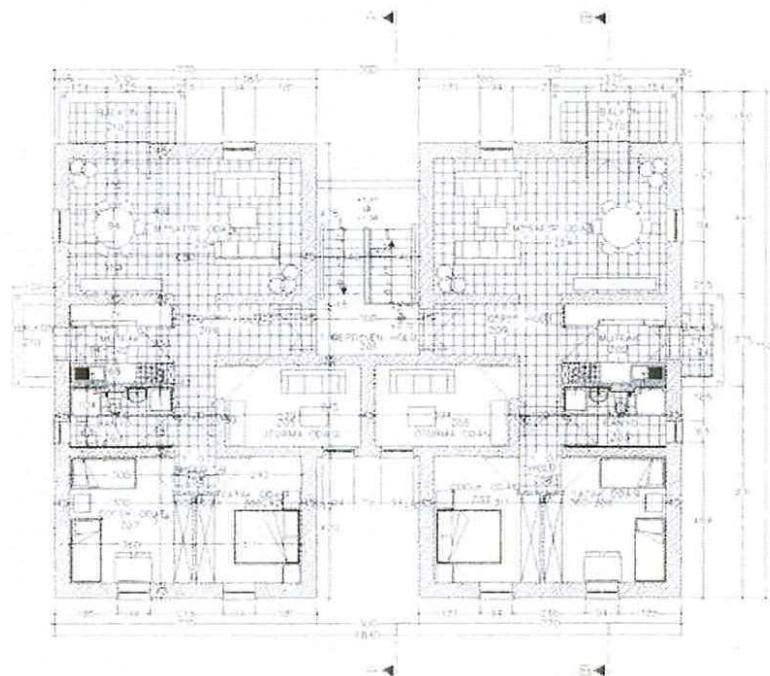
Üçüncü kerpiç yapı planı, 1997, Altınoluk
